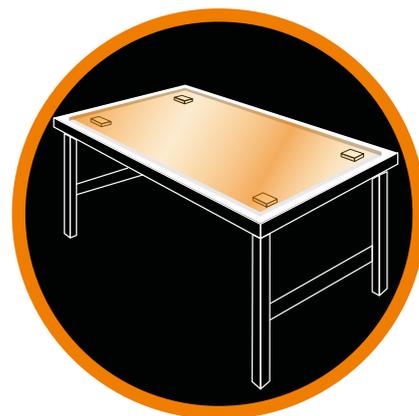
Mesa de trabajo limpia con bloques de soporte para la aplicación en el lugar de instalación de la cinta de adhesión estructural Reforac UPPER BOND
